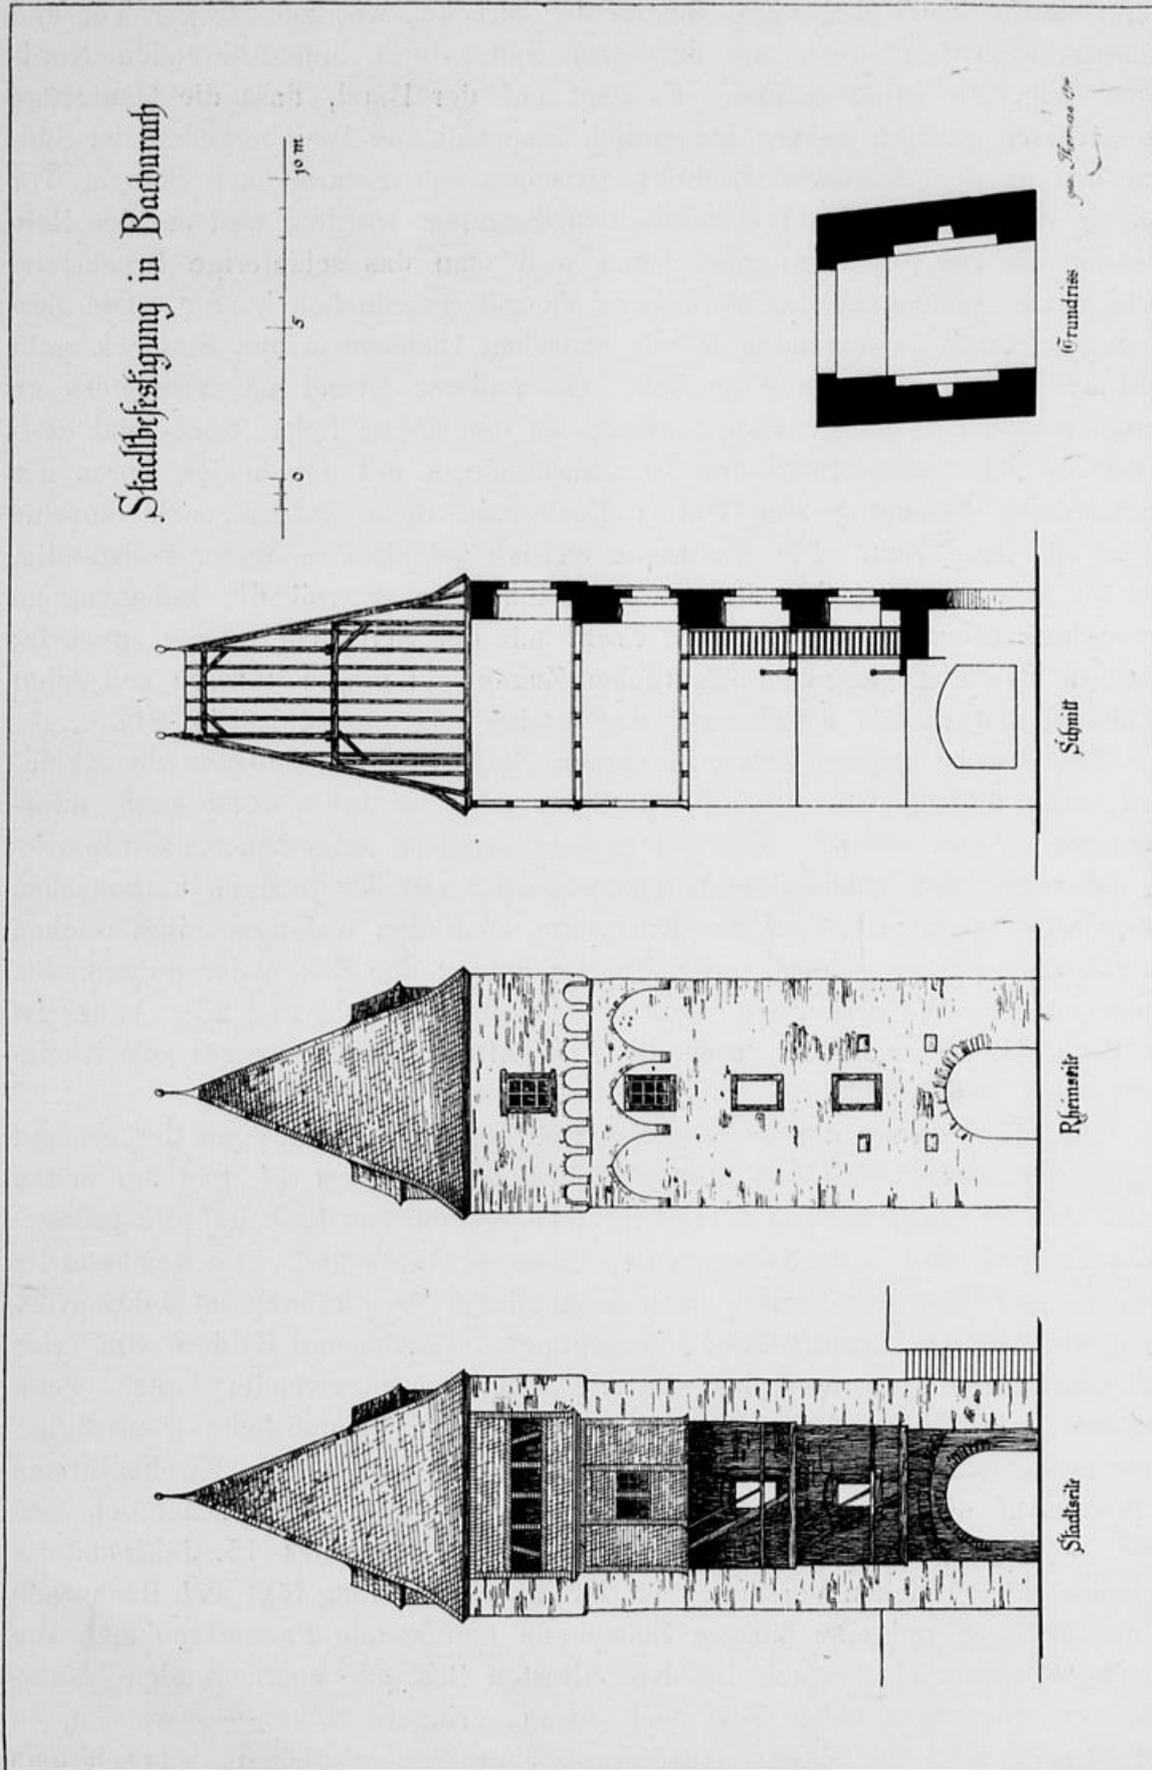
Bacharach. Aufrisse, Schnitt und Grundriss des Münzturmes nach der Wiederherstellung.
